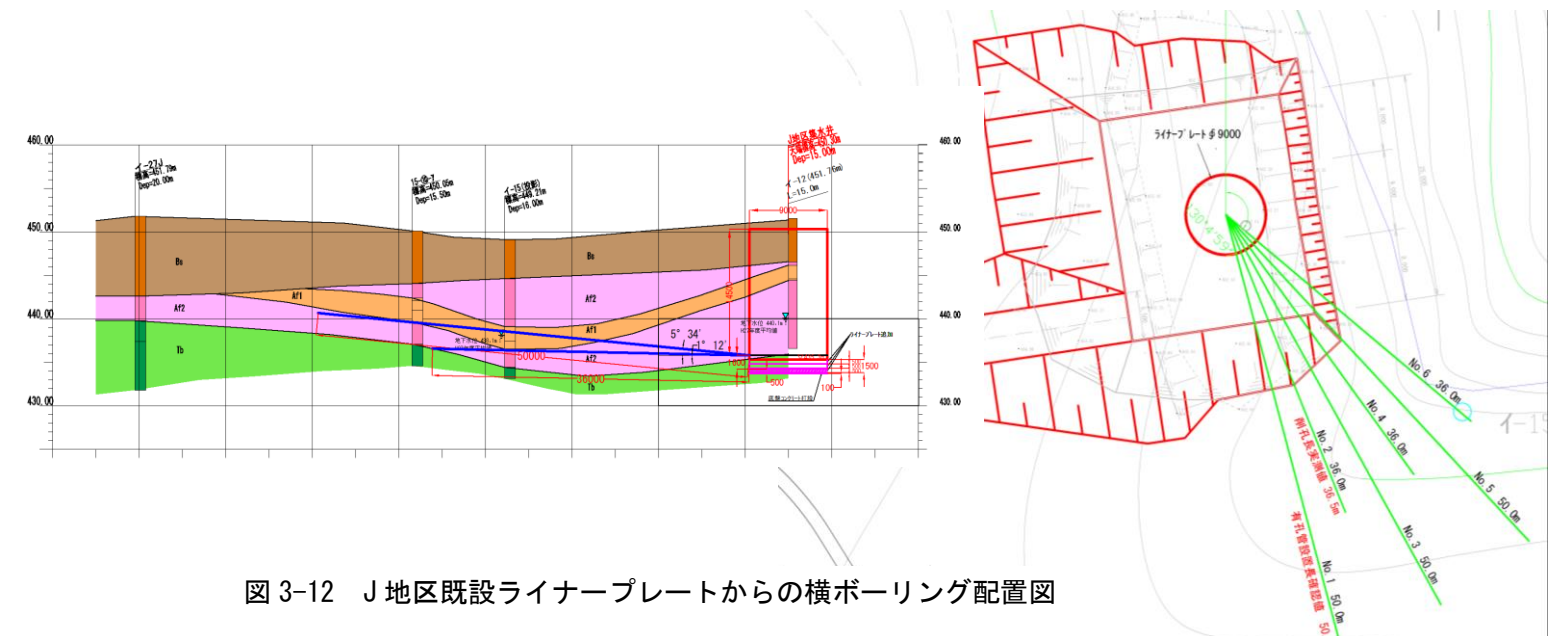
J 地区既設ライナープレートからの横ボーリング配置図
